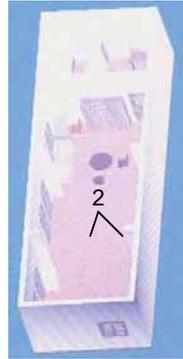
Apreciación de anchura de muros que implica propiedades térmicas hacia el espacio interior de la galería.
